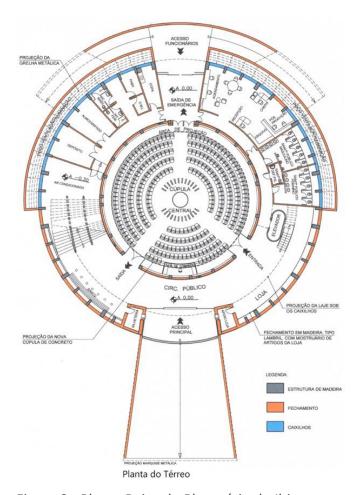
Planta Baixa do Planetário do Ibirapuera
